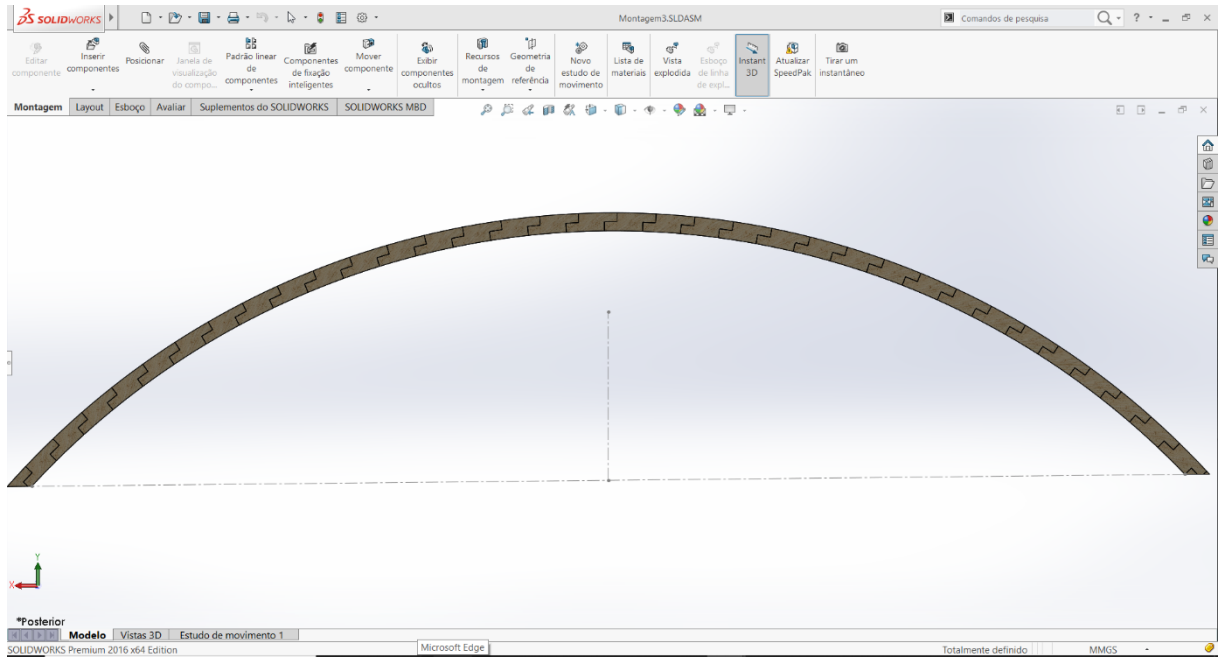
Maior viga-pilar montada com as partes encaixadas
